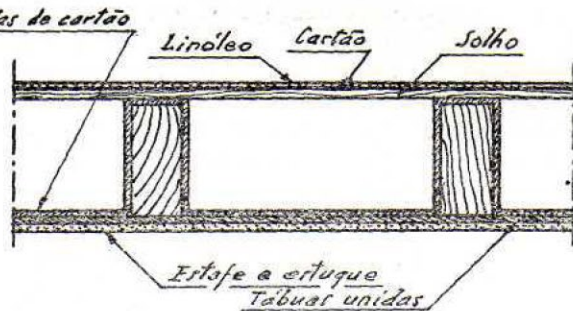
PAVIMENTO E TECTO DE MADEIRA
